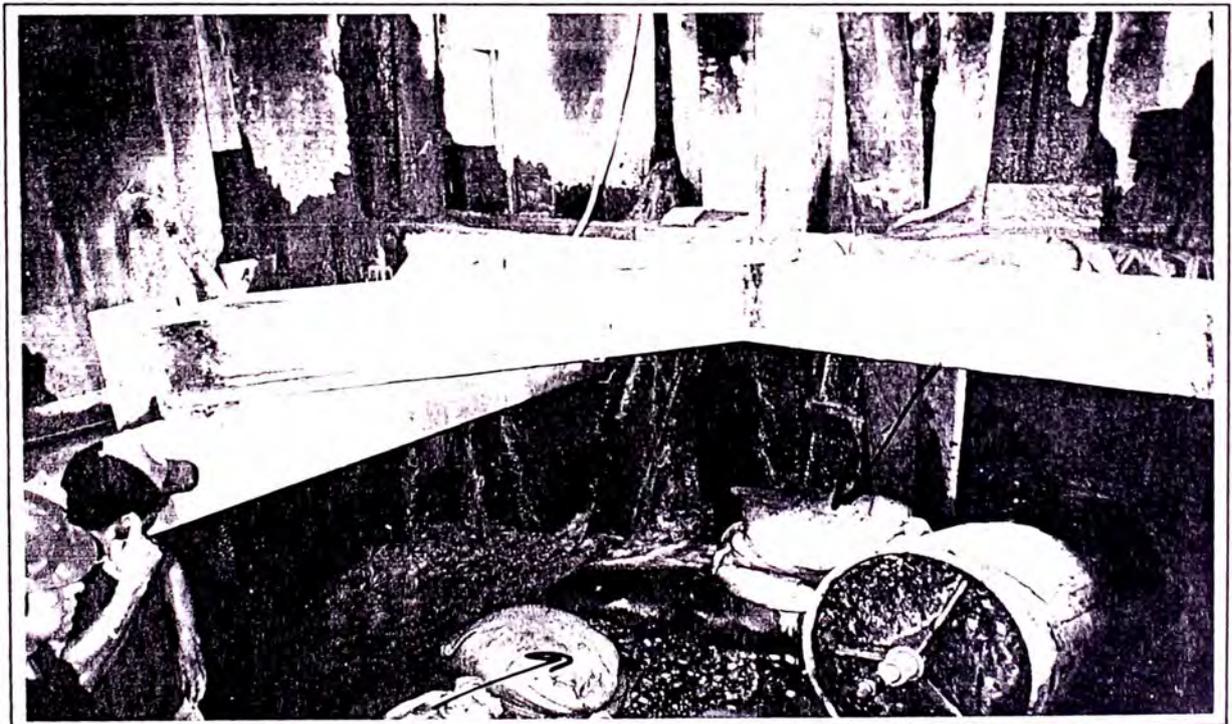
Ubicación de tubería y colocación de bolsas de arena para desviar ingreso de agua.
